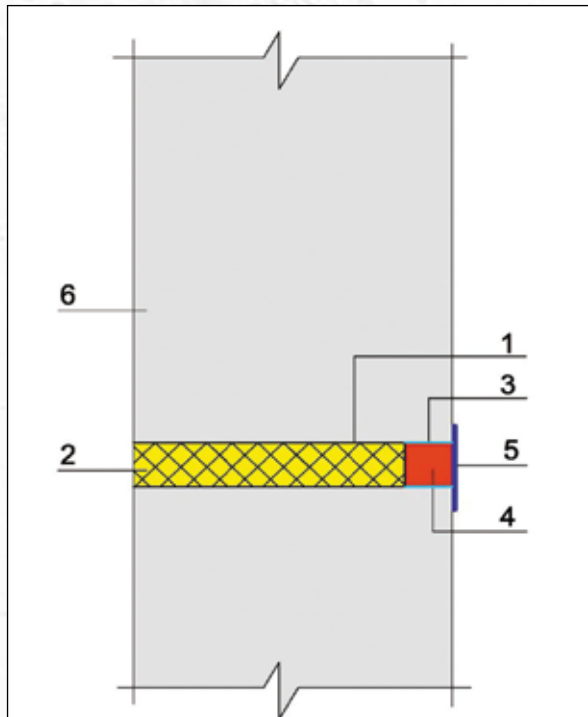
Общая схема гидроизоляции отверстий от стяжек опалубки
